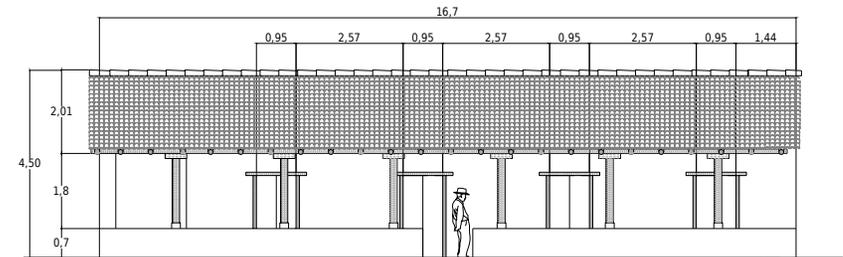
FACHADA POSTERIOR DE LA VIVIENDA TIPO.
